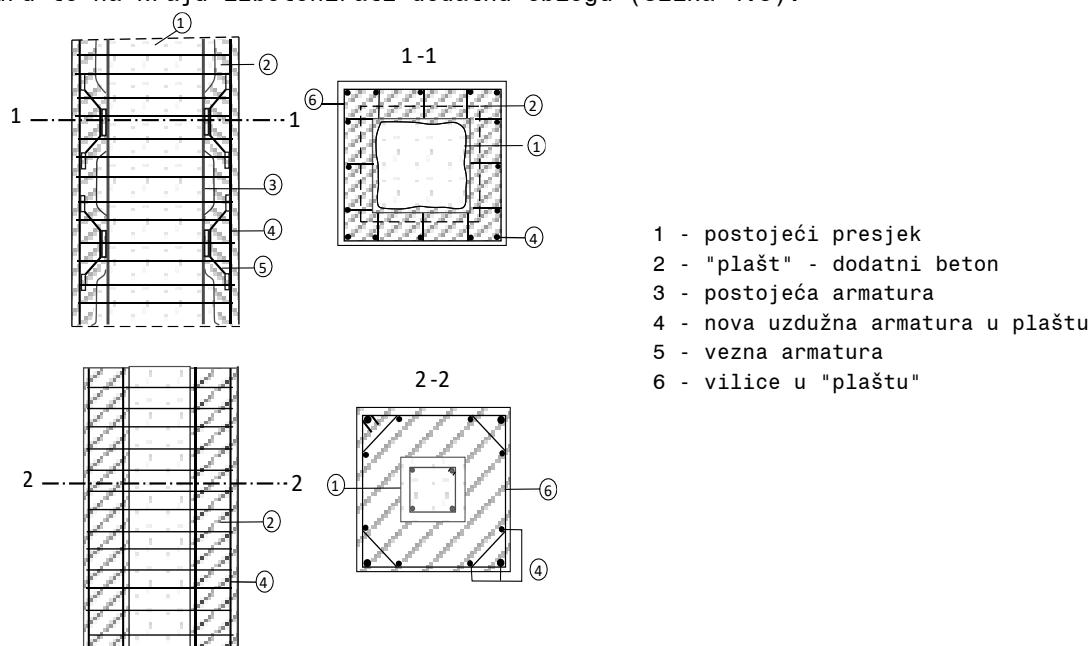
Lokalno saniranje stupova za dublja oštećenja
